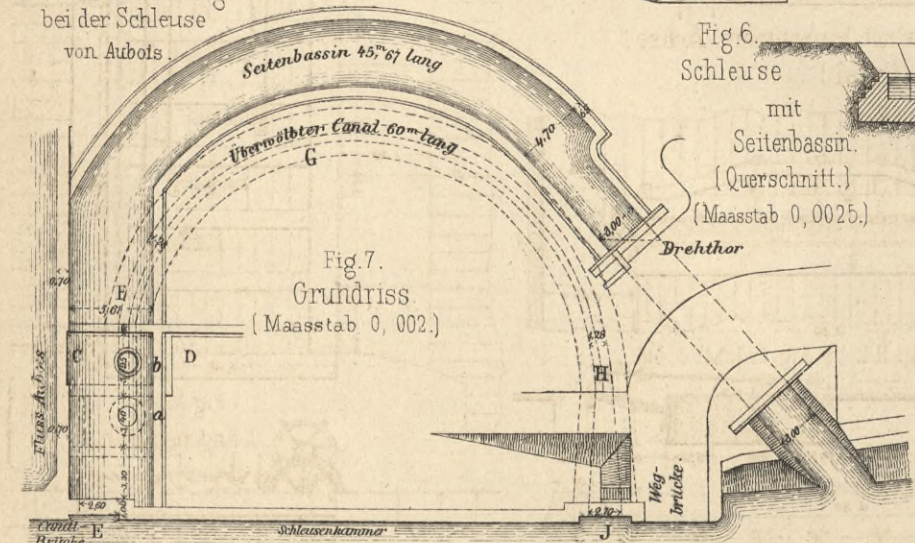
Grundriss (Maasstab 0,002.)
